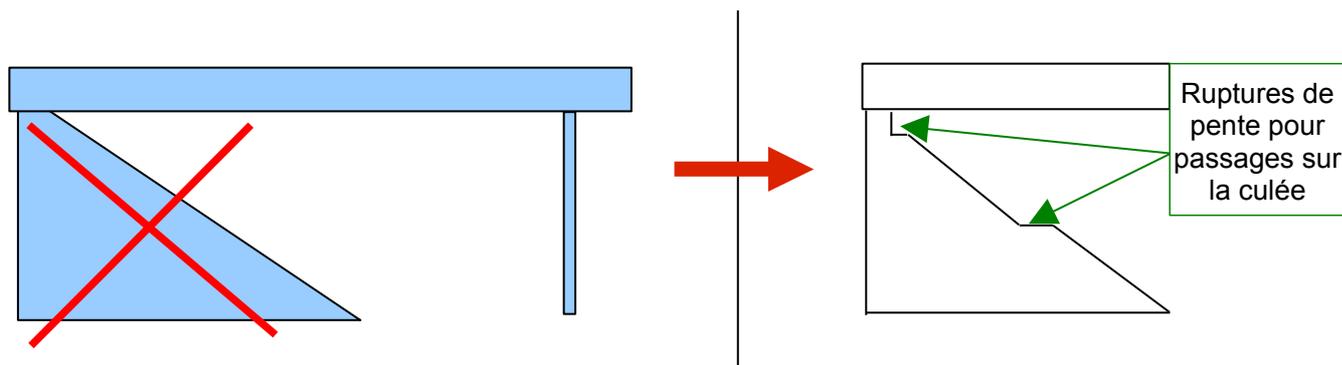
passages sur la culée pour la petite faune (coupe transversale)
